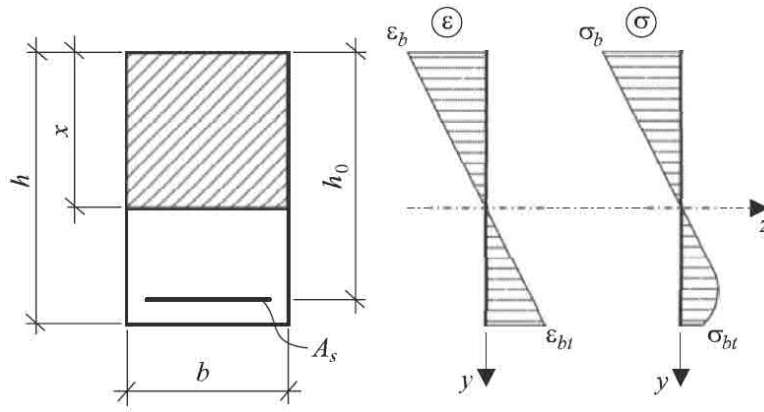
Распределение деформаций и напряжений по высоте сечения балки
